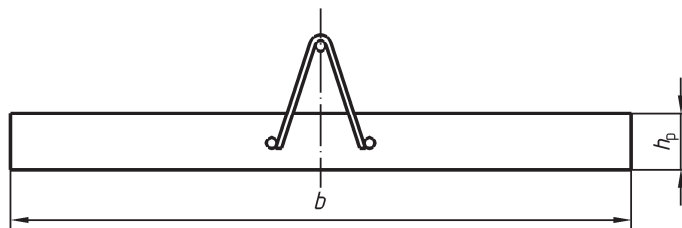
Sonderfall einer Fertigteilplatte aus Stahlbeton mit einem einzelnen Gitterträger
